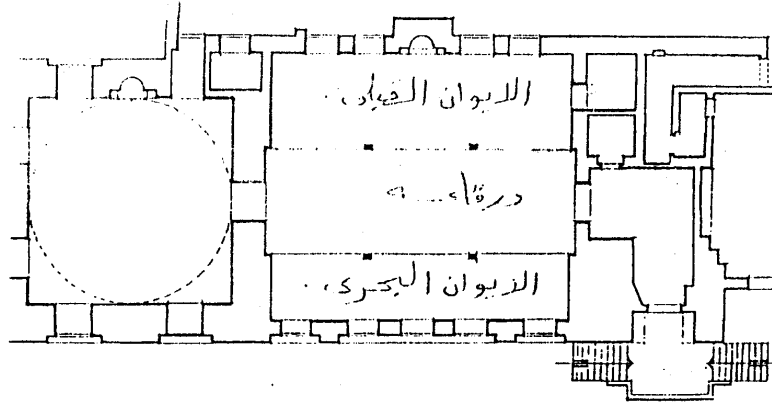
مسقط أفقي لمسجد فرج بن برقوق المعروف بزاوية الدهيشة بالقاهرة
